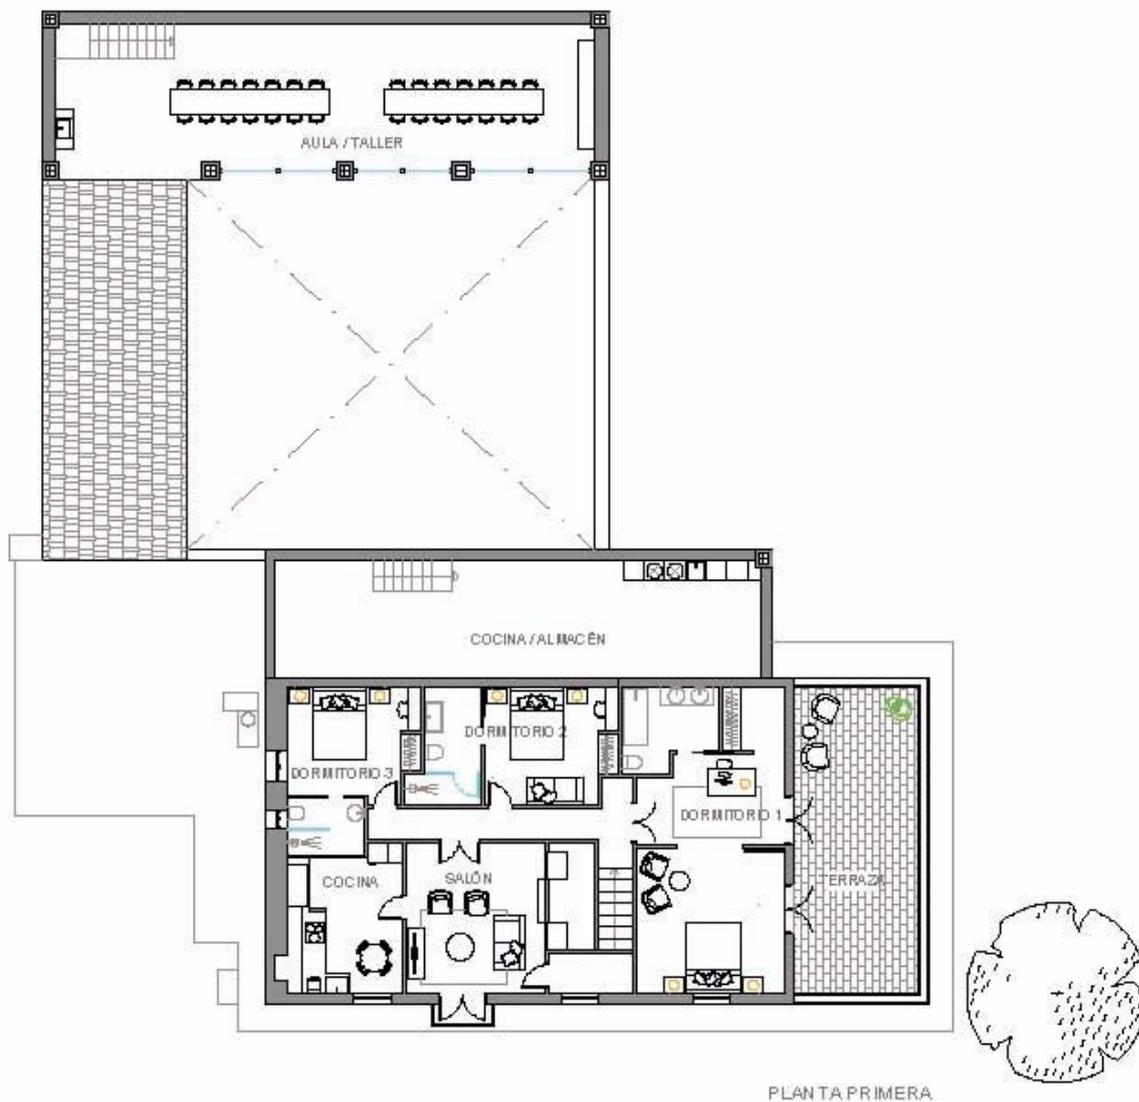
Plano de planta primera Cambio de uso Caseta Bas. Fuente Propia. 2016
